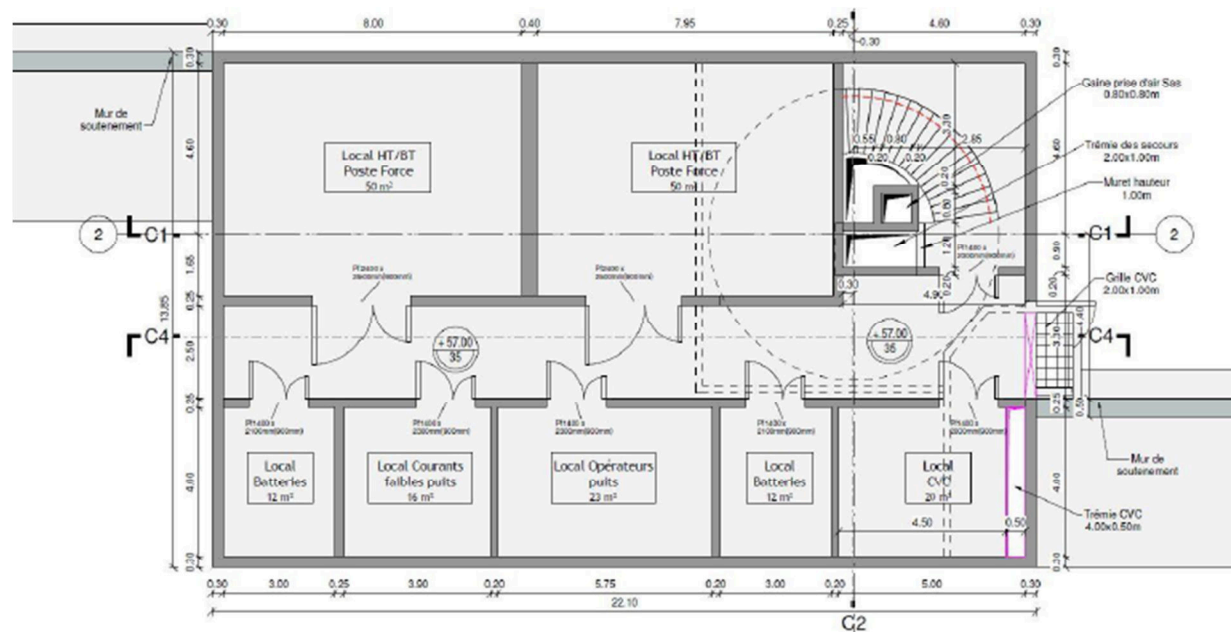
Vue en plan du niveau N0 de l'OA 3503P
